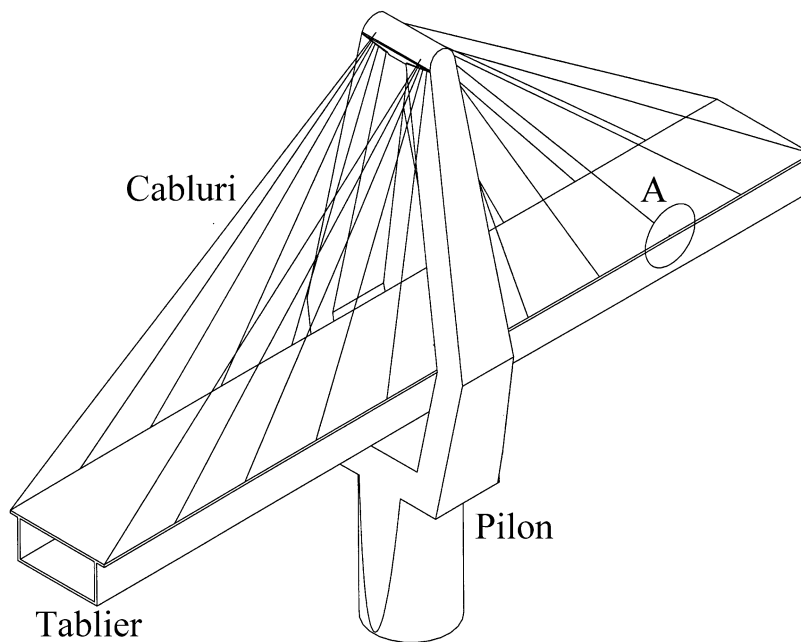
Exemplu de structură cu tablier suspendat pe pilon din construcția podurilor svelte moderne.
